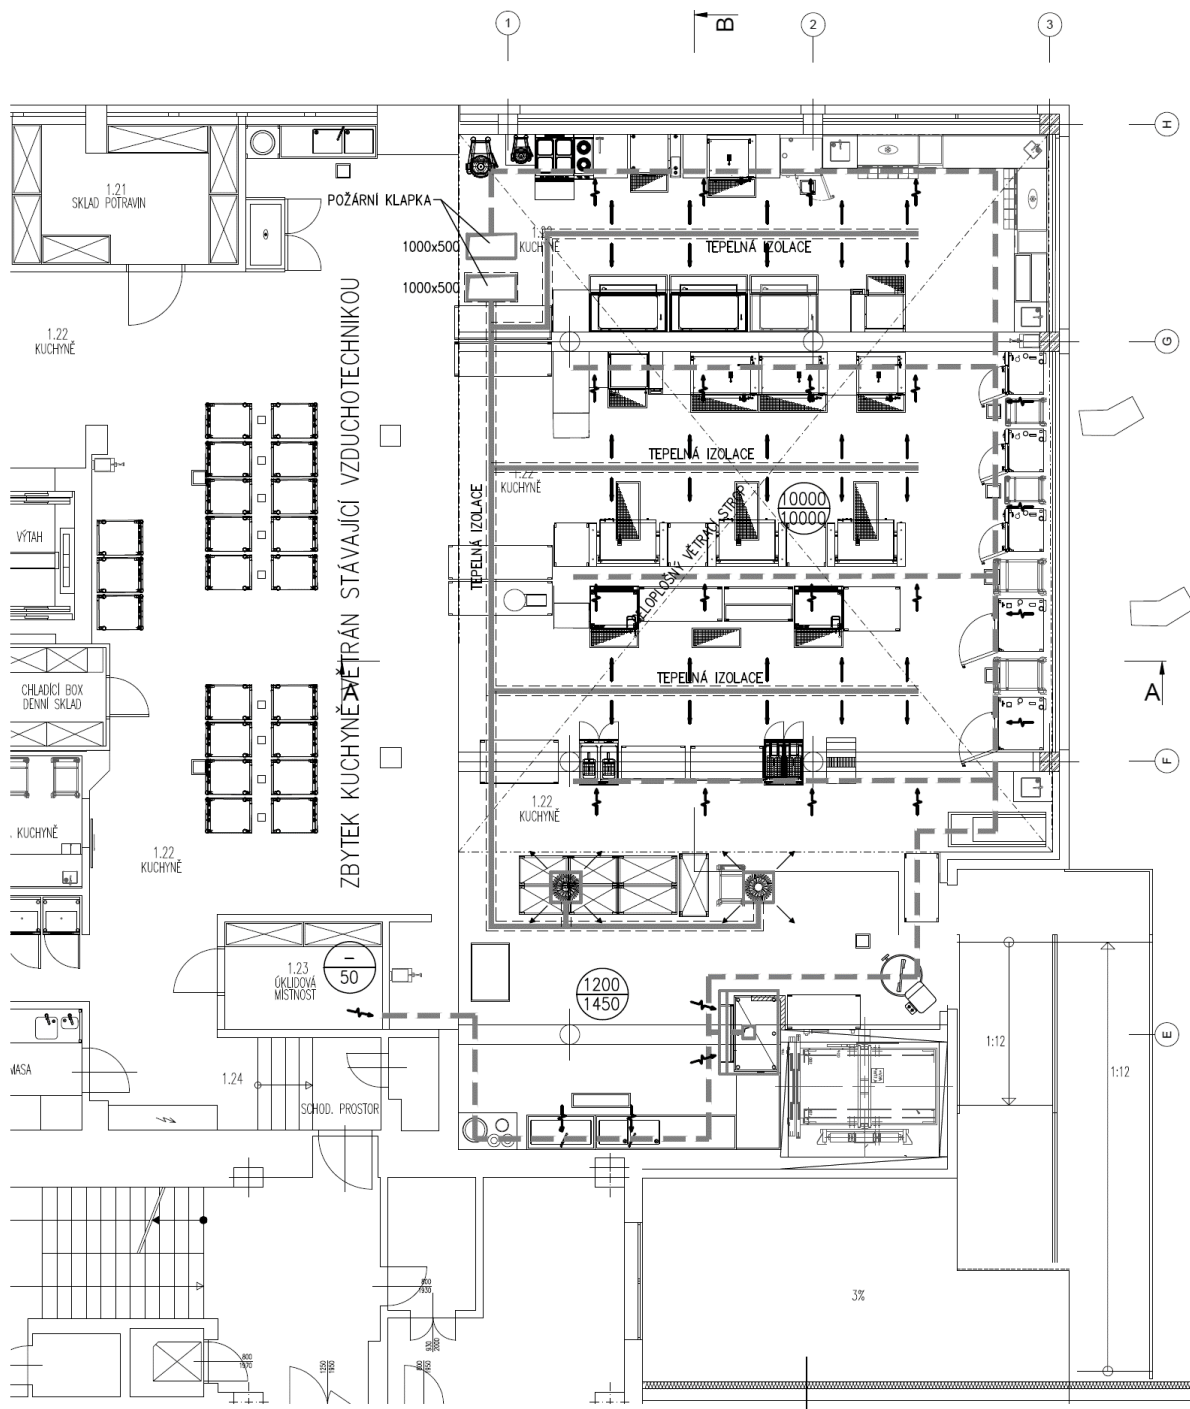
Umístění stacionárních zdrojů hluku do exteriéru, půdorys 1NP
